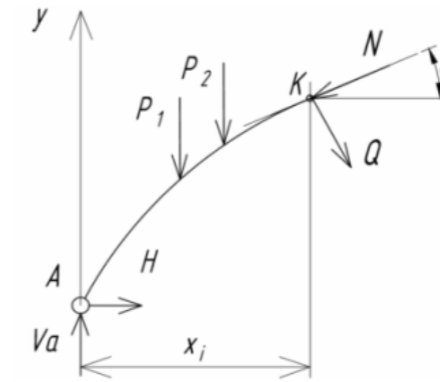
Схема усилий при расчете железобетонных балок со средним относительным пролетом среза
